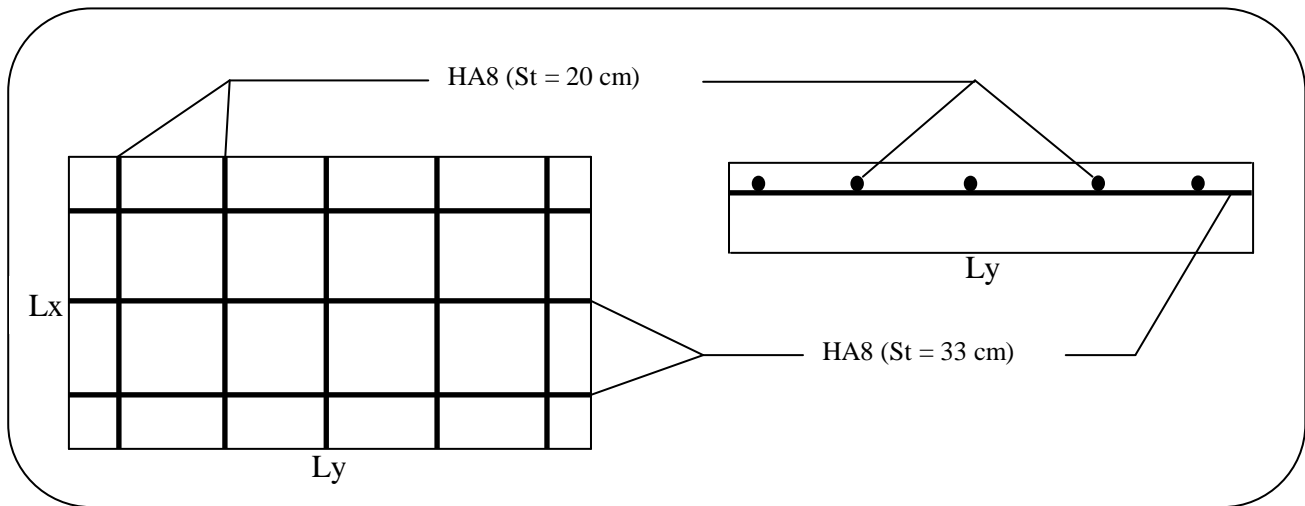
Schéma de ferrailage du palier intermédiaire
